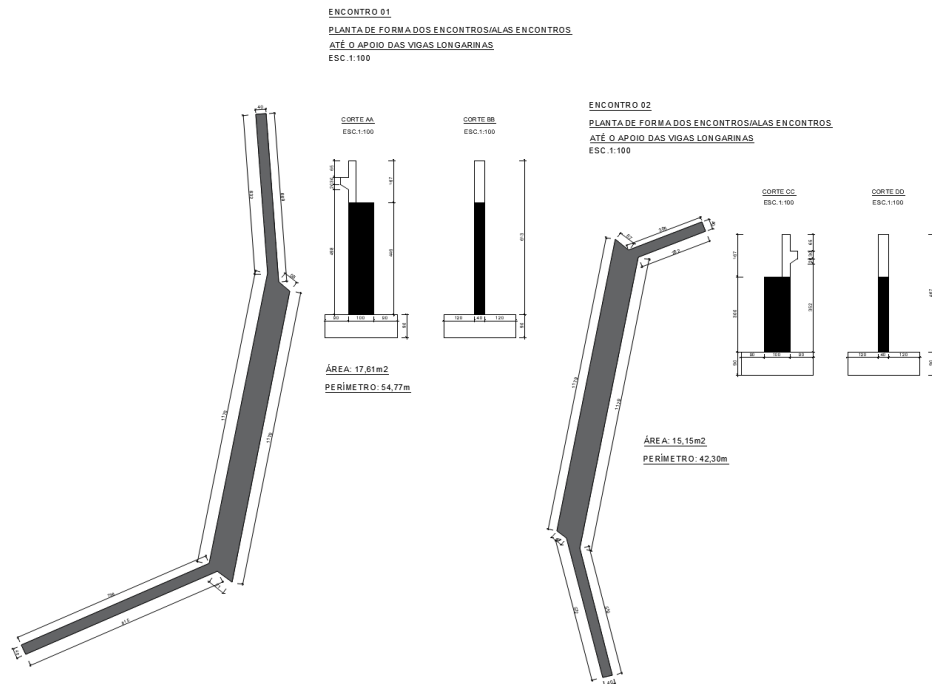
Vista Planta dos apoios - encontros/alas 01 e 02 do Projeto Básico da Ponte localizada no futuro Contorno de Santa Maria de Jetibá / ES.
